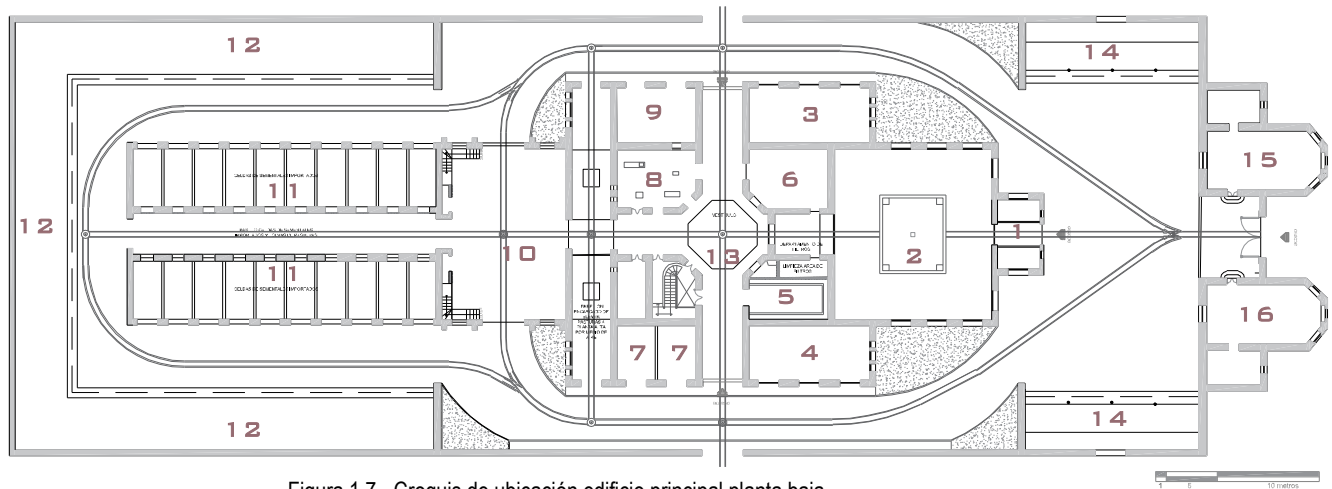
Croquis de ubicación edificio principal planta baja
